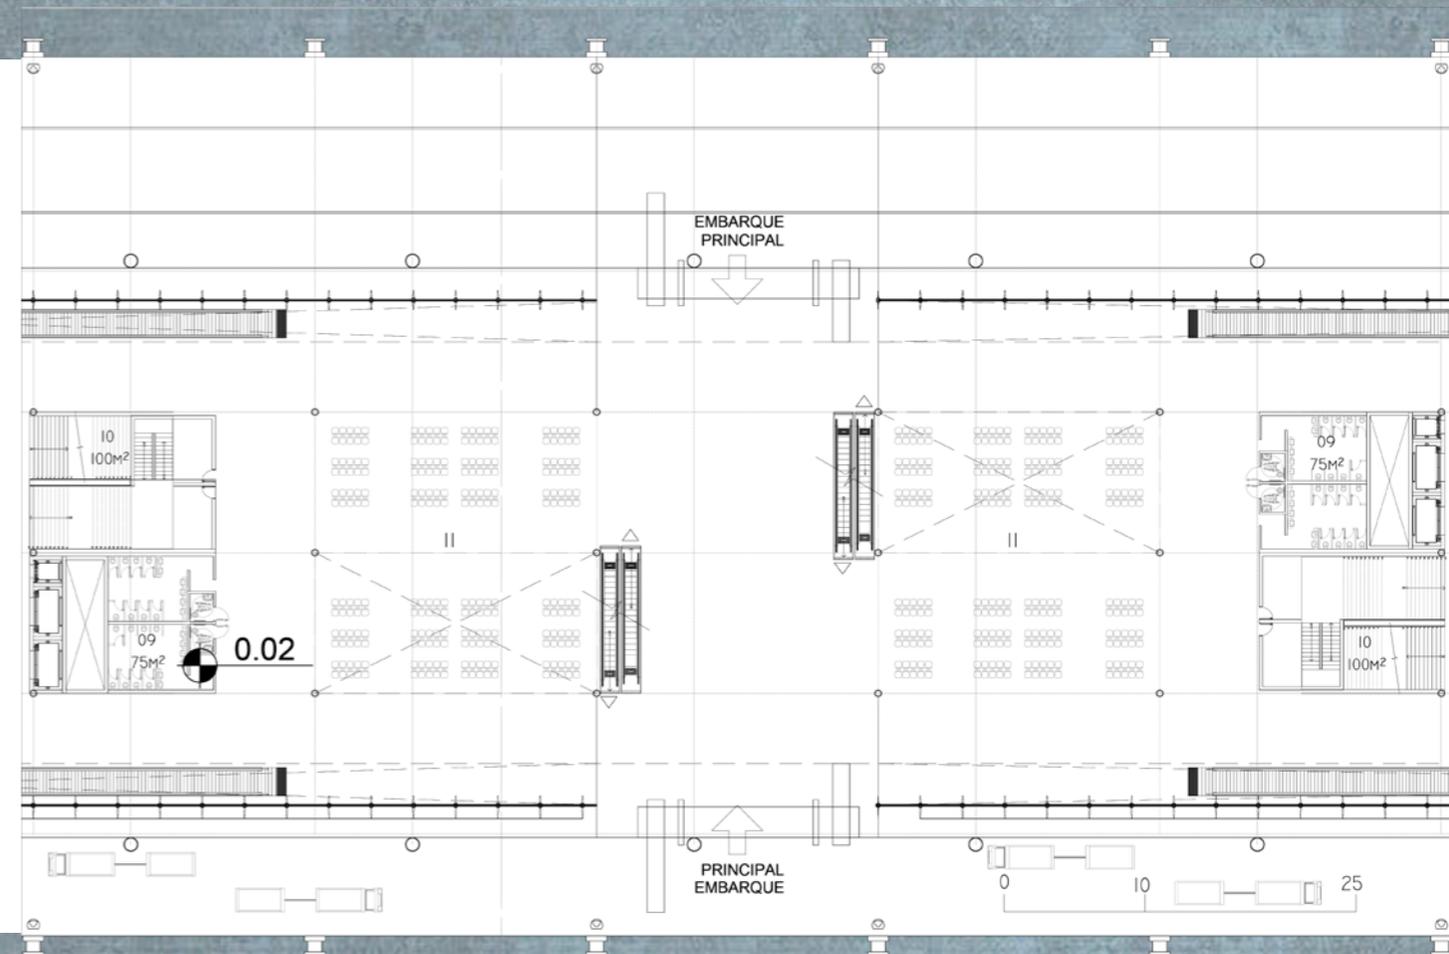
Planta Térreo. Fonte: Autoria própria.
